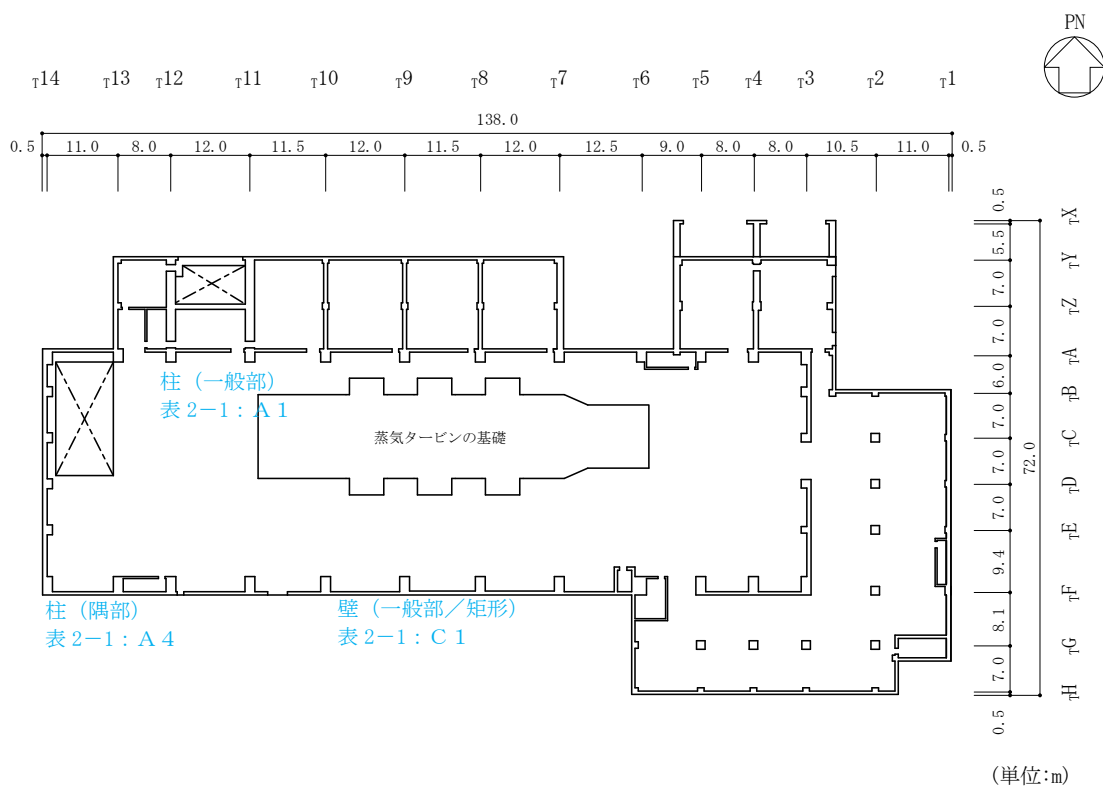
(4) タービン建物の概略平面図 (EL 20.6m)
